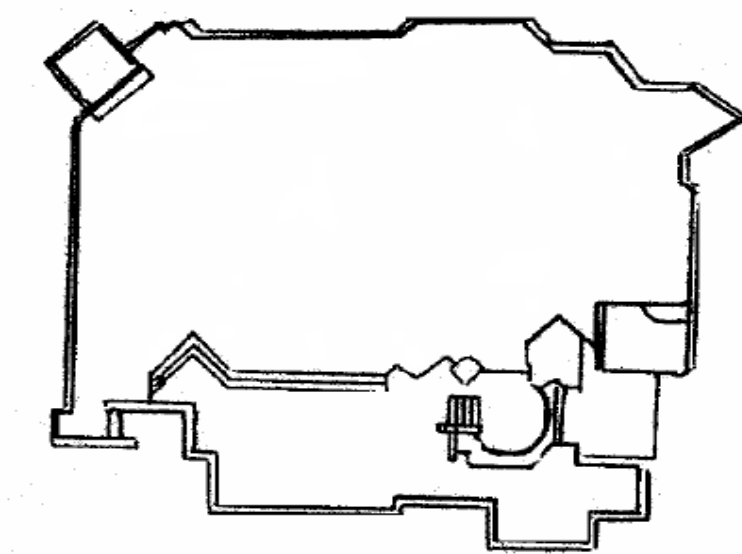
Planta da igreja de Nossa Senhora da Boavista (Porto) [3]
